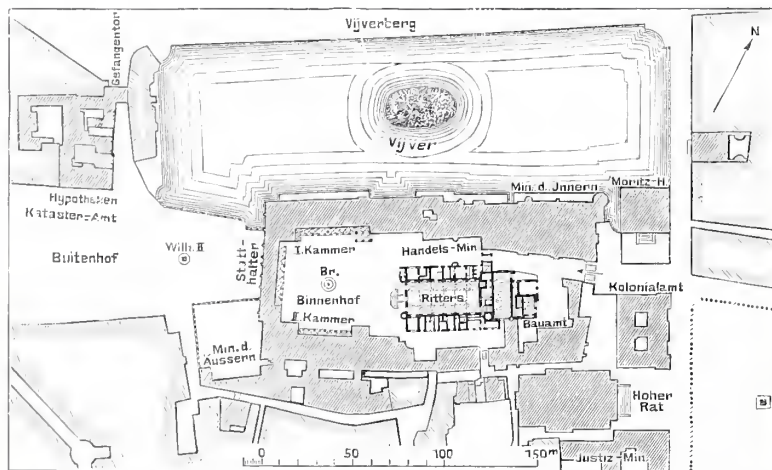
Binnenhof. Lageplan und Grundriß im Jahre 1891.
